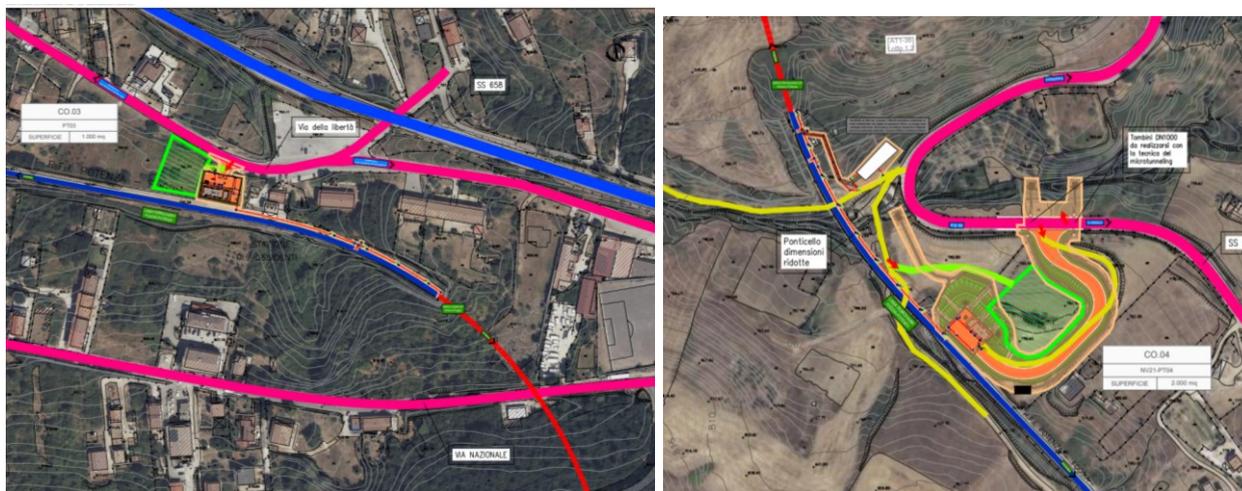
Planimetria con indicazione delle aree di cantiere e della viabilità connessa. Galleria Monte Quattrocchi lato Foggia (sinistra) e lato Potenza (destra) (Fonte: Allegati alla Lista di controllo)
